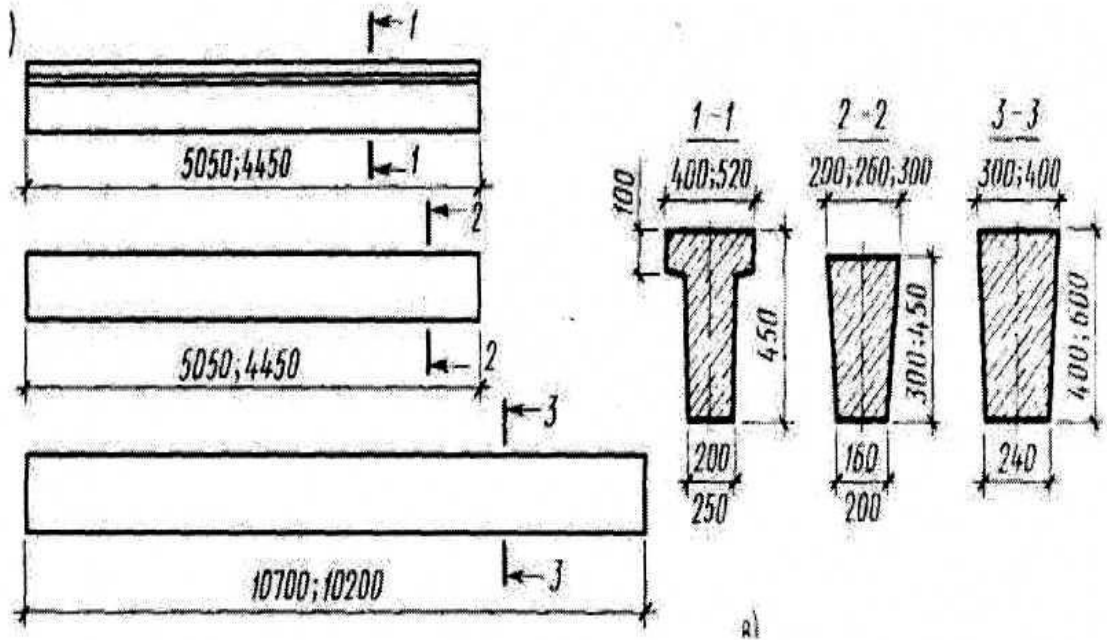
Фундаментные балки для шага колонн 6 и 12 м
